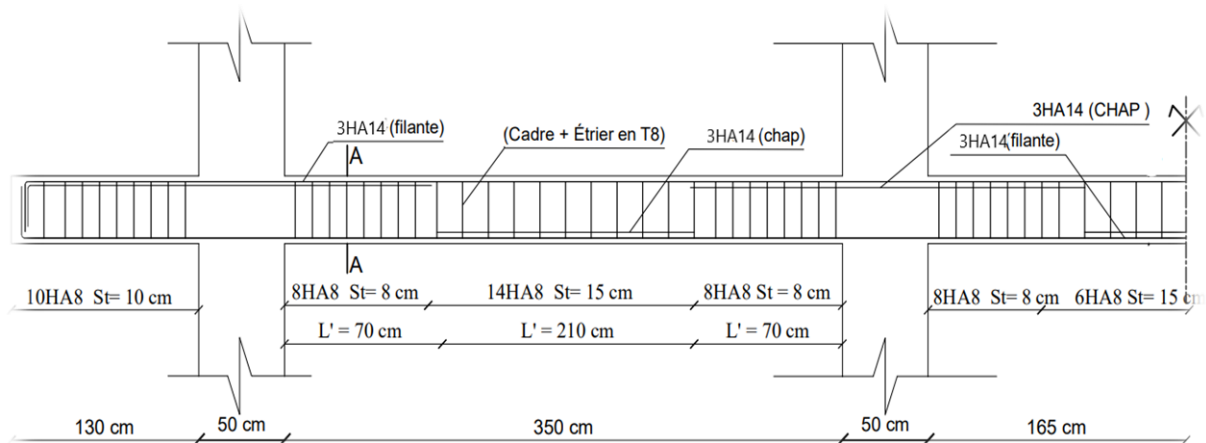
Schéma de ferrailage des poutres secondaires en travées
